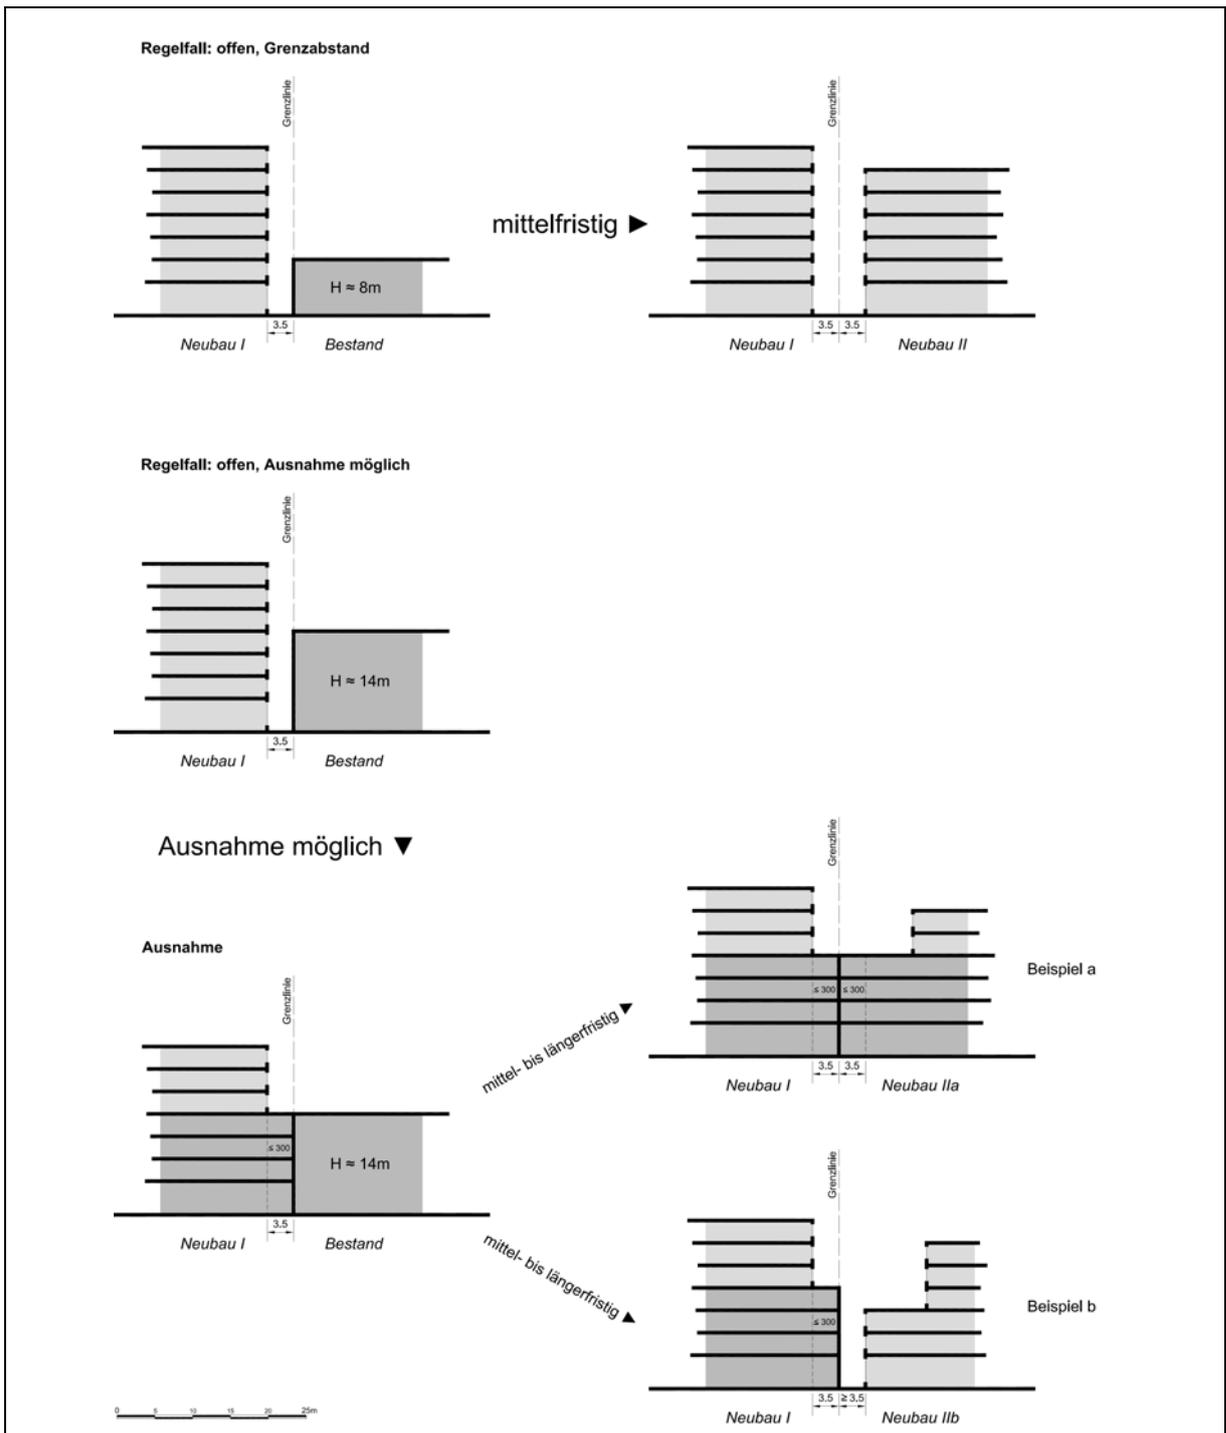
Variantenskizze möglicher Grenzbebauungen, Fassaden entlang der Wien-Strasse
